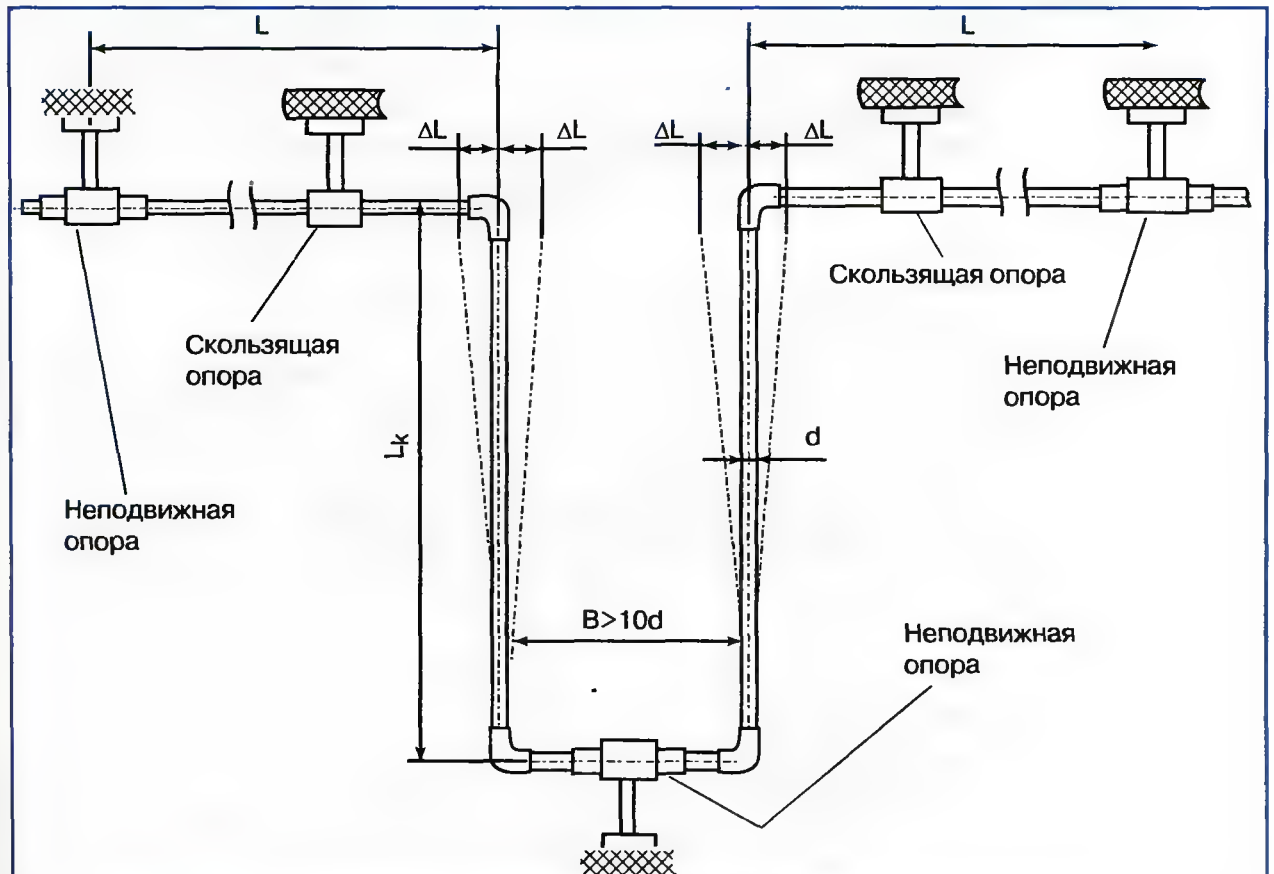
П-образный компенсатор для полипропиленовой трубы
